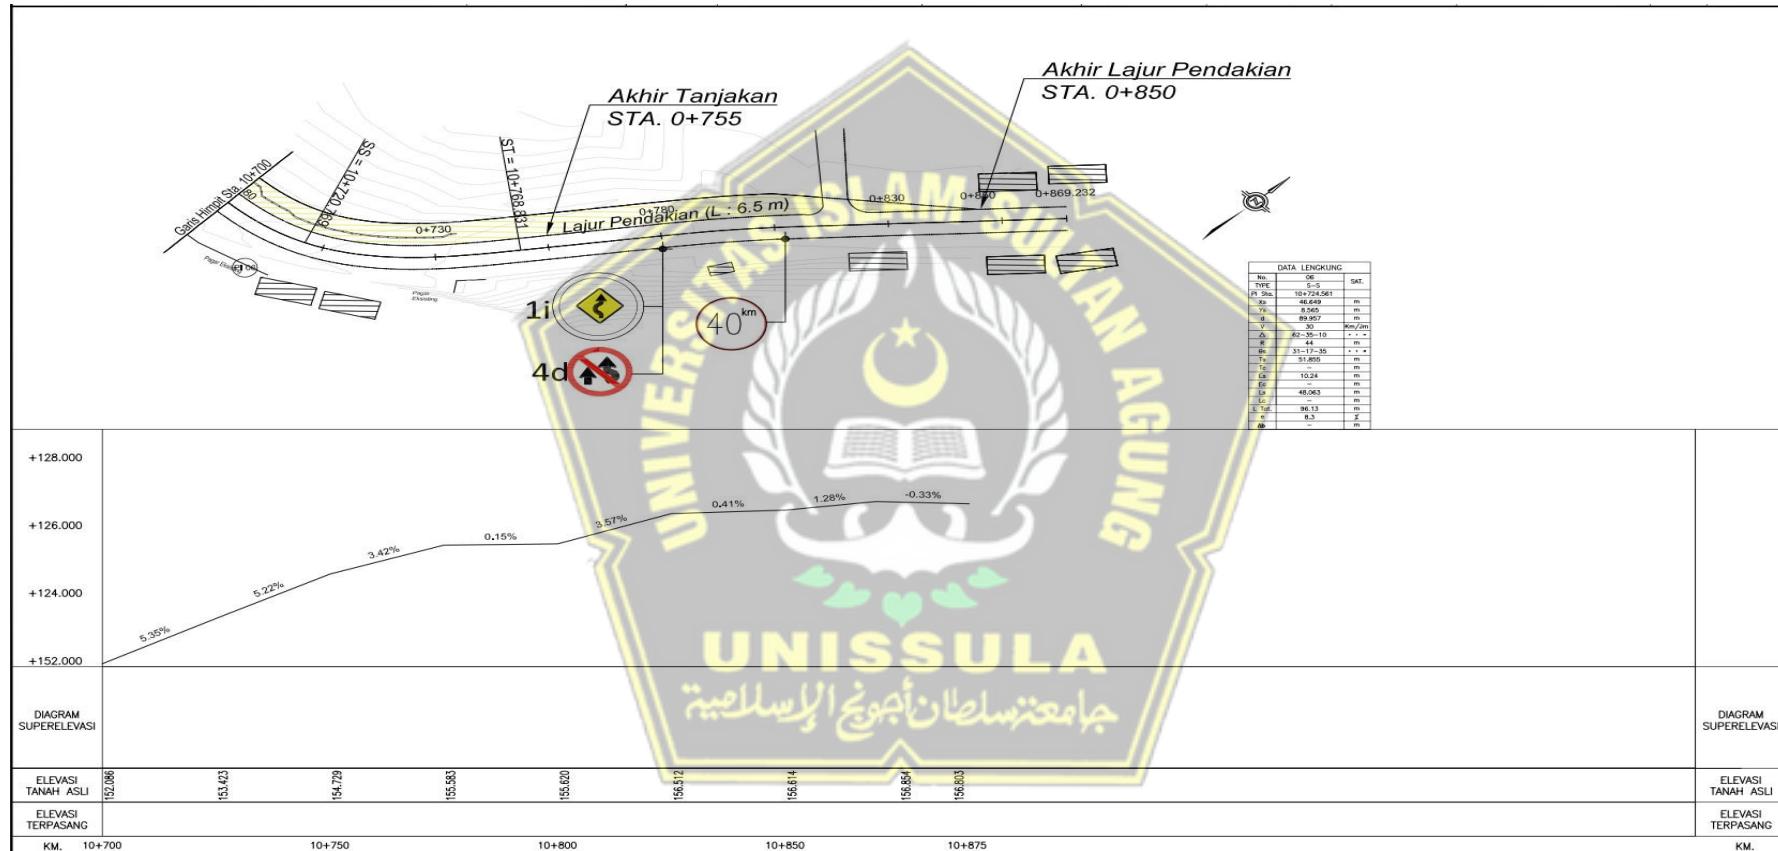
Alinyemen Horizontal Rencana Lajur Pendakian
